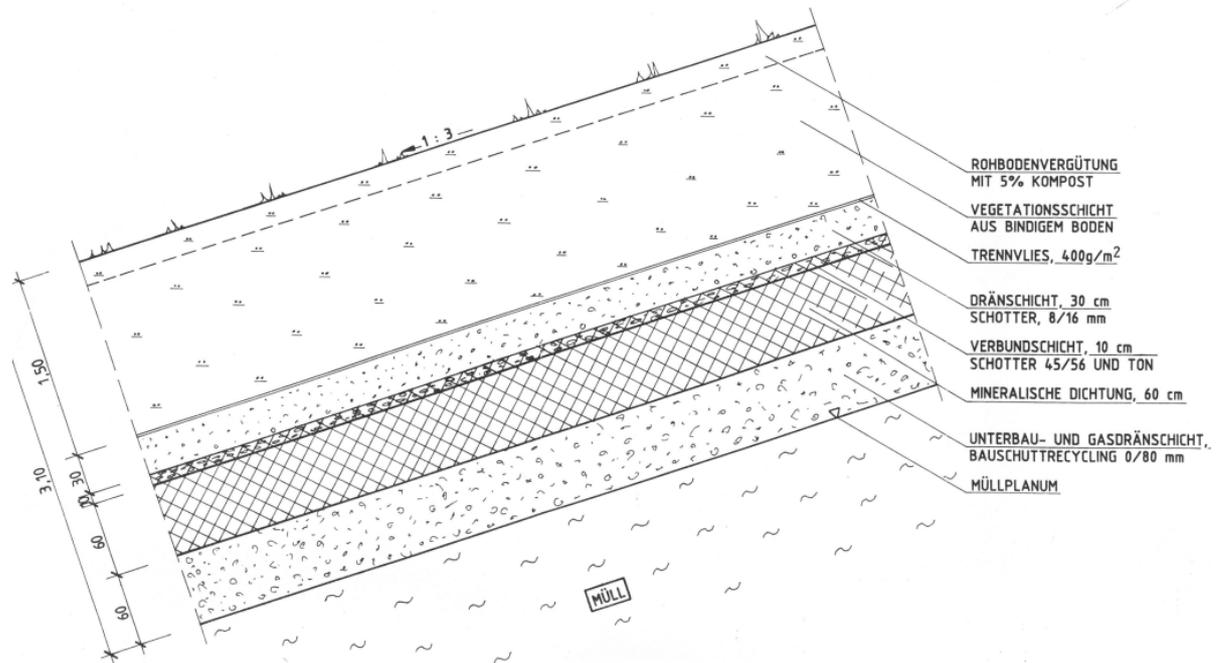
Aufbau Oberflächenabdichtung Bereich „Erweiterungsfläche“,
